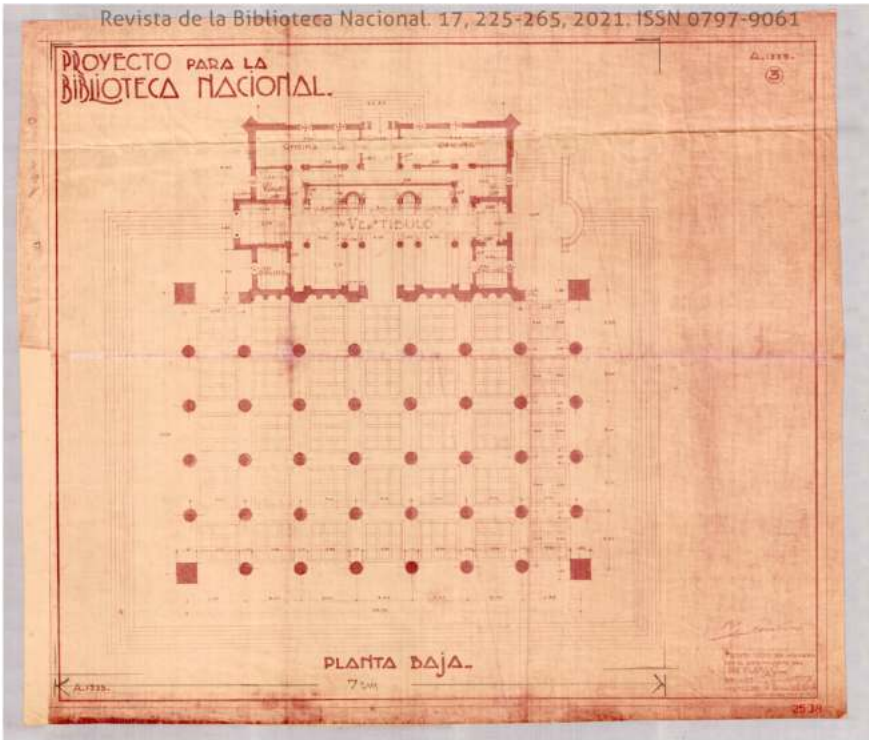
Planta baja del proyecto para la BN realizado en base al anteproyecto de Vilamajó de 1926. Archivo IHA, plano 2538. Copia del original, en el archivo del MTOP.
